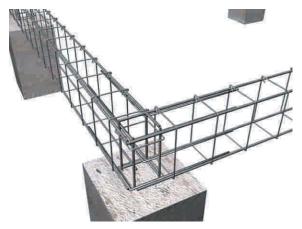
12: Encuentro de esquina de la viga de fundación, donde los fierros del pilote de hormigón pasan a formar parte de la enfierradura de la viga.
